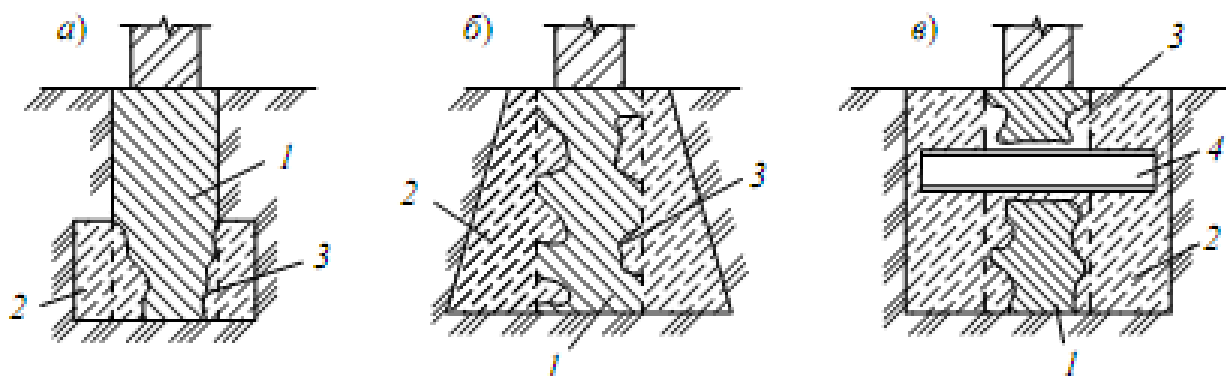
Схеми посилення стрічкових фундаментів бетонними обоймами:
